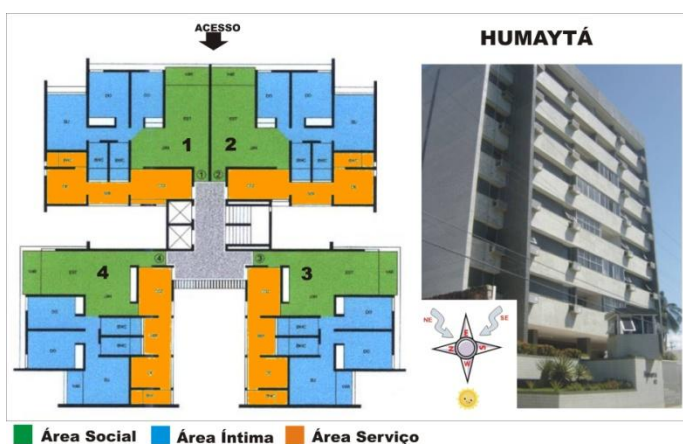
Planta baixa do pavimento tipo do Edifício Humaytá, foto da fachada Leste e esquema de direção dos ventos
